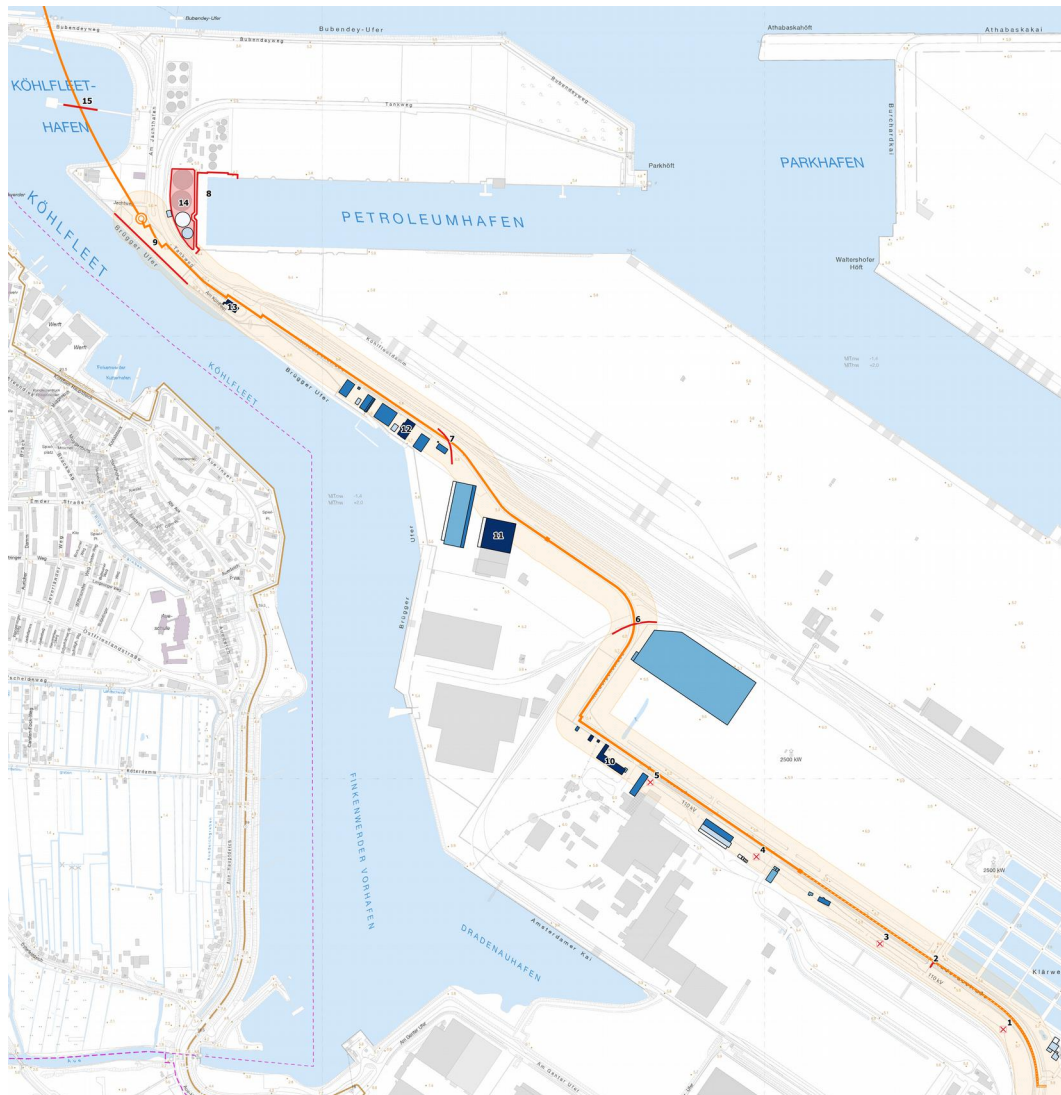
Ausschnitt Karte Betroffenheitsanalyse südlich der Elbe, geplante KWK-Anlage Dradenastraße bis Startschacht Jachtweg
